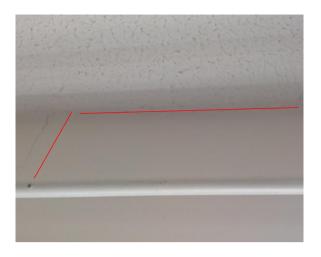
Fissuras sob a laje do piso superior (VISTA A)
